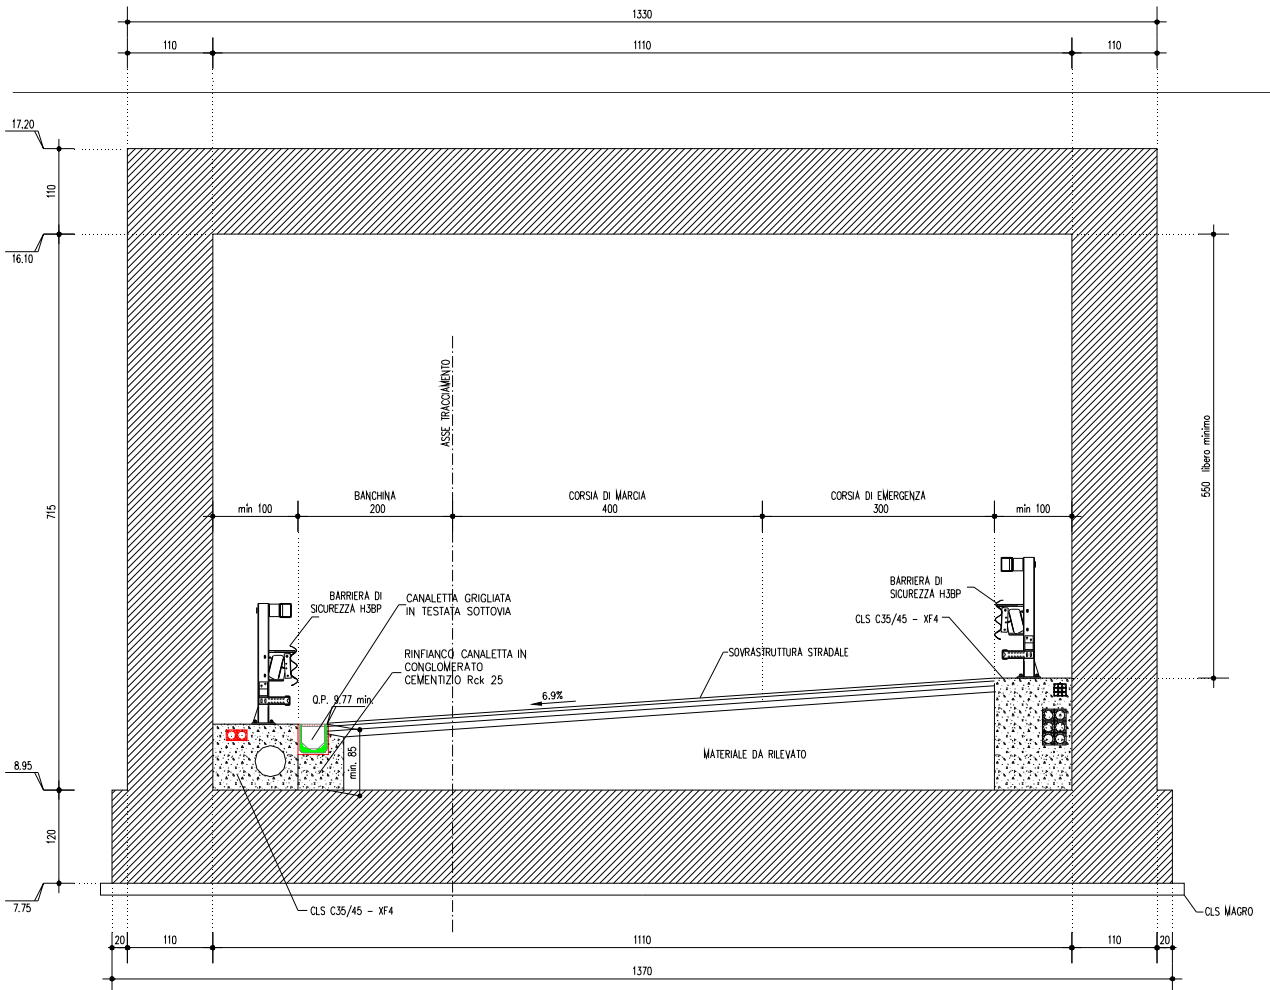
SEZIONE TRASVERSALE SOTTOVIA SCATOLARE
